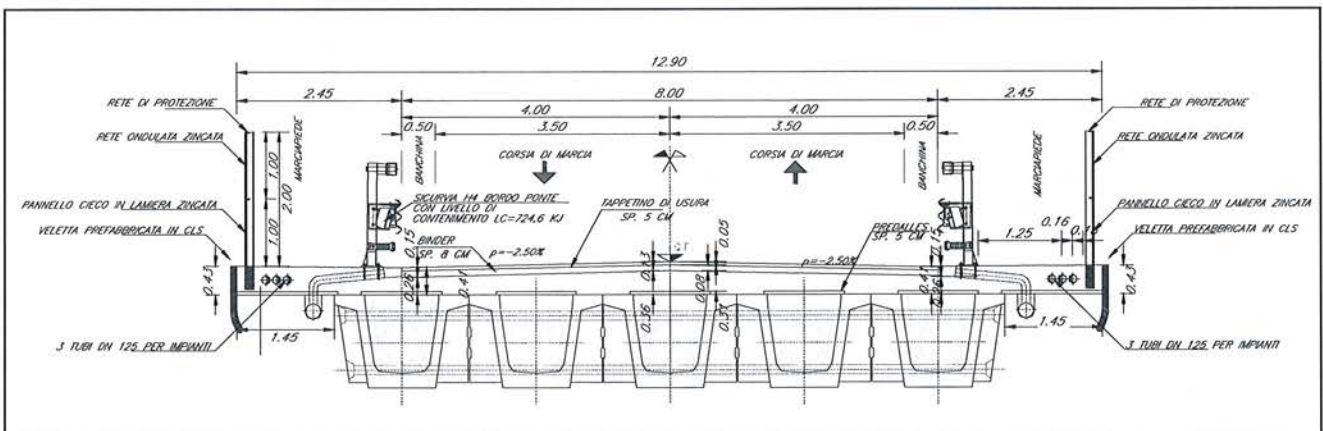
Sezione tipo cavalcaferrovia campata. L=25.00 m
